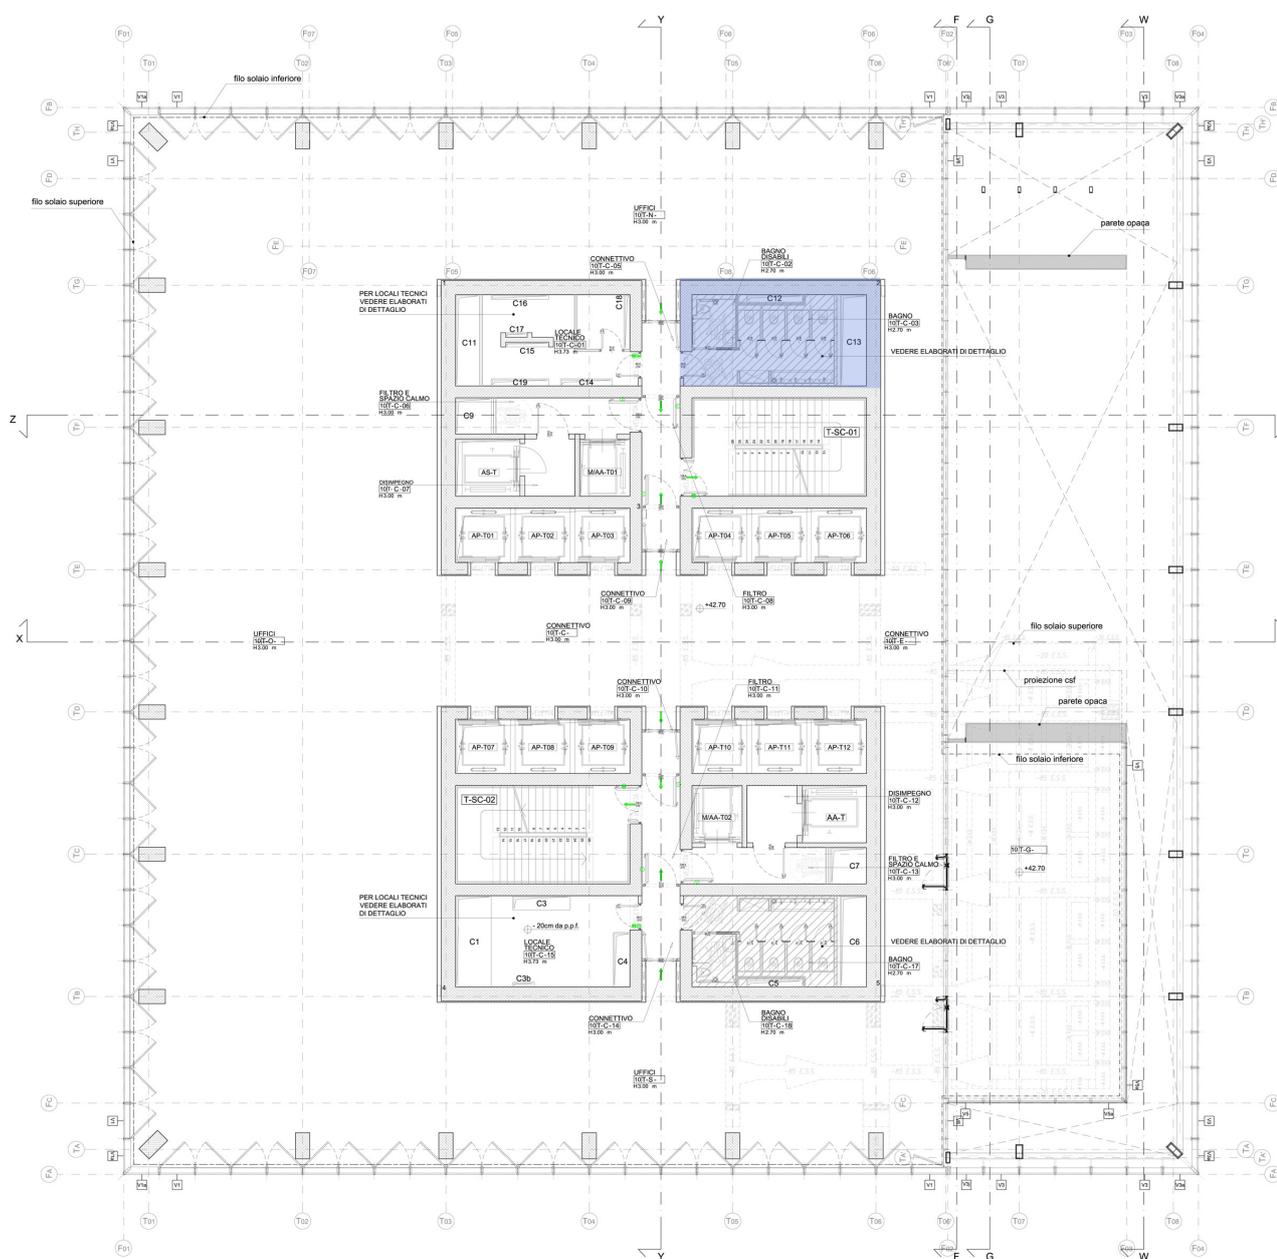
Planimetri Piano 10 Torre Regione Piemonte.
